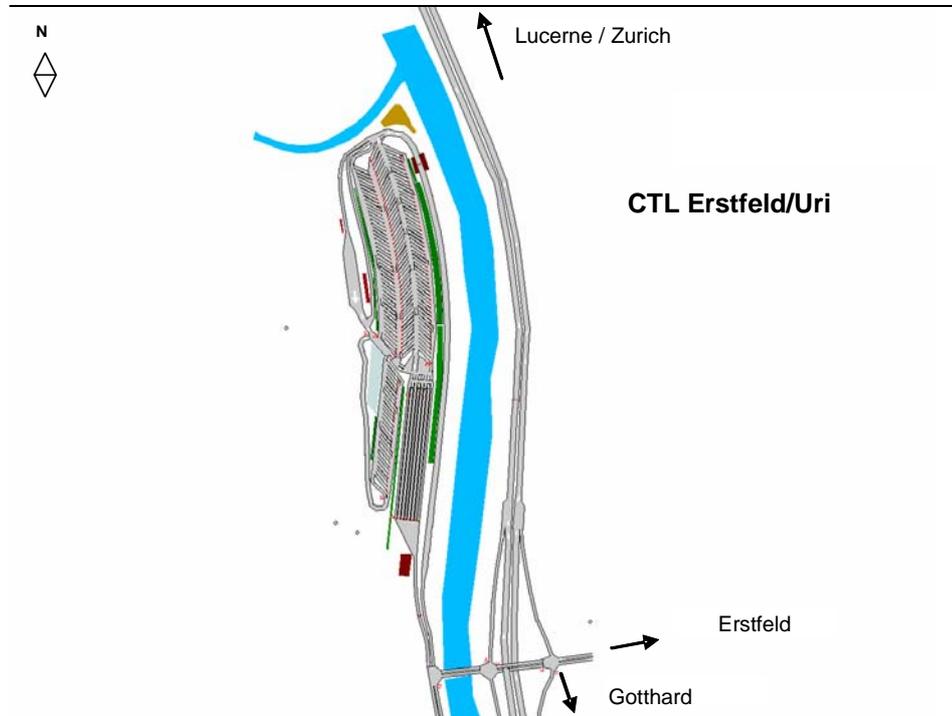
Vue d'ensemble du CTL d'Erstfeld.
